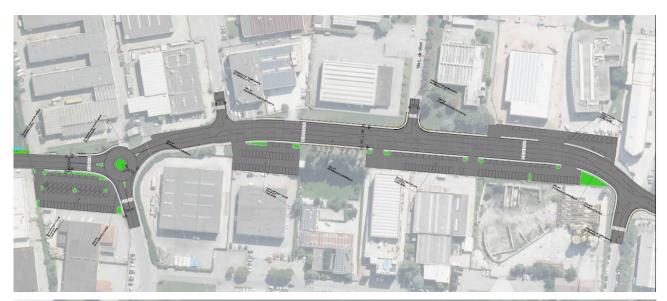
Planimetria dell'adeguamento via Galilei e di via Meucci-SP della Pilla.
